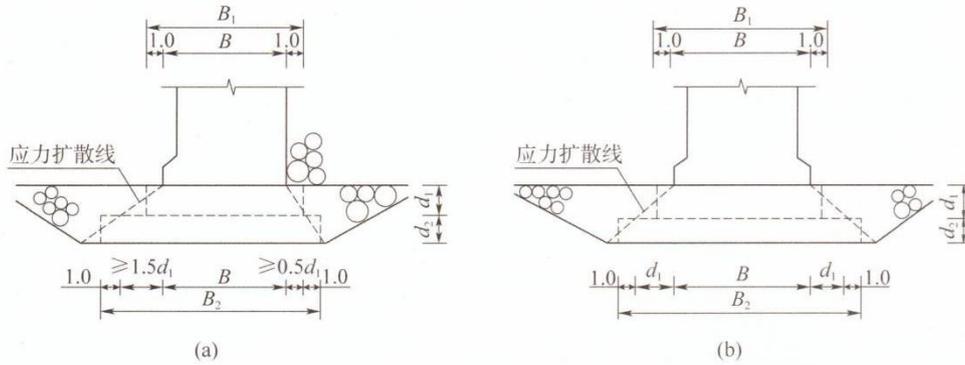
基床夯实范围示意图（尺寸单位：m）
